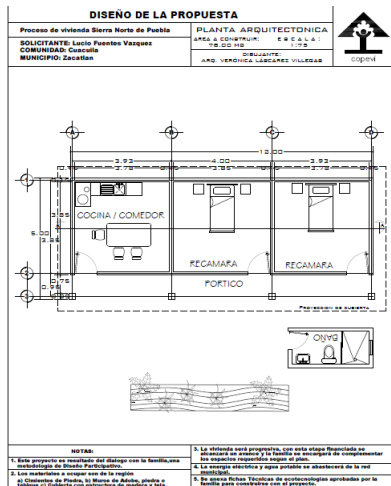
Planta arquitectónica. Prototipo "Hilera"
